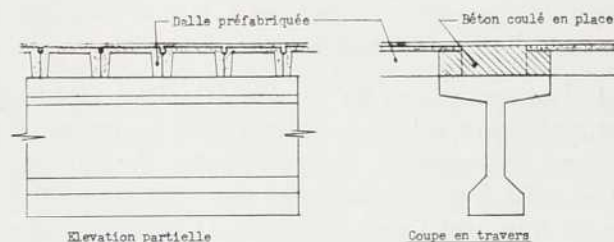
POUTRES PRÉCONTRAINES ET DALLES PRÉFABRIQUÉES
